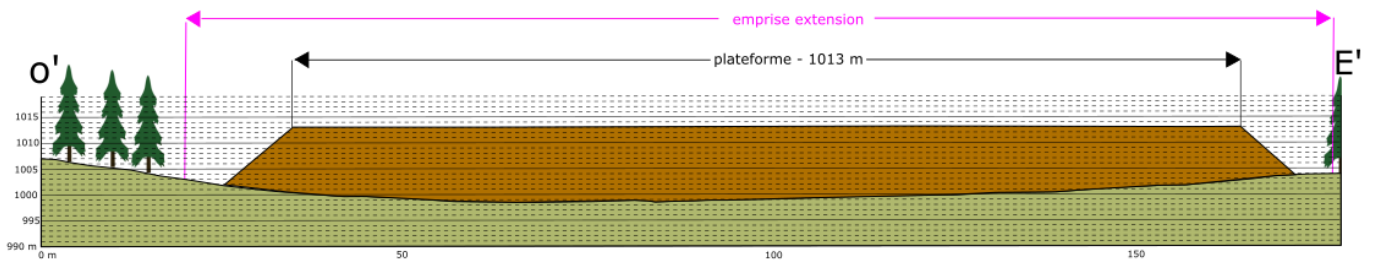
Coupe Ouest / Est du projet au niveau de la zone d'extension
